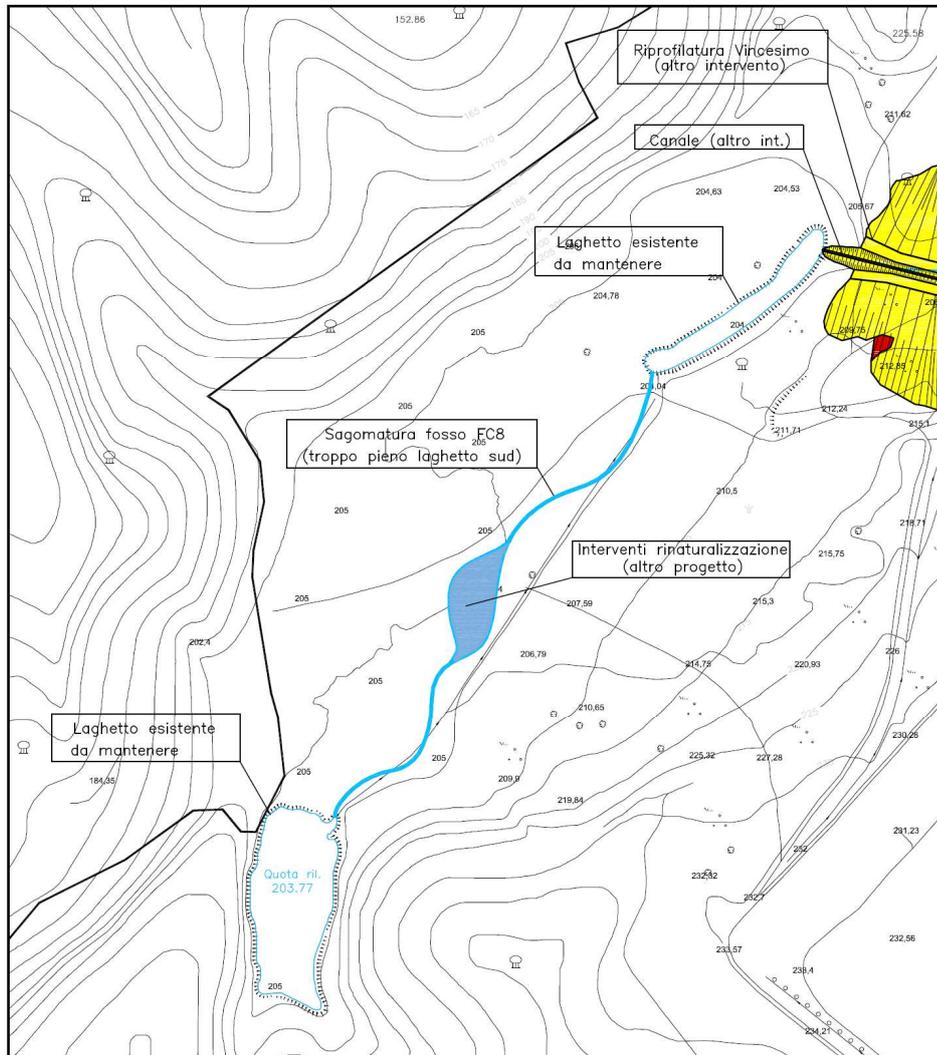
Planimetria dell'intervento (in rosso le aree di colmata del laghetto esistente)
